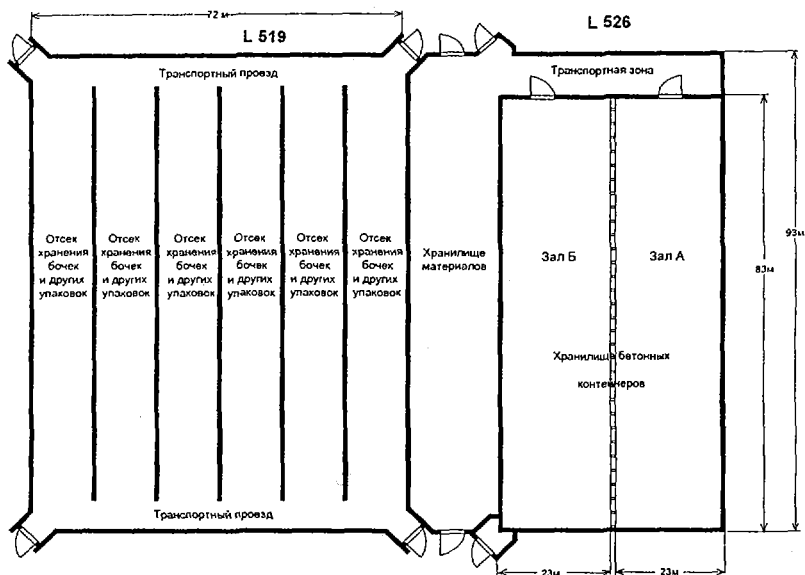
План хранилища кондиционированных отходов в КФК (Германия).
